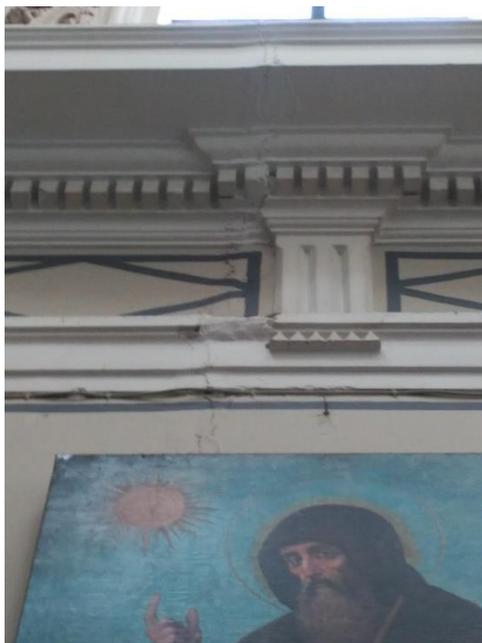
Grieta muro Sacristía. Fuente propia
